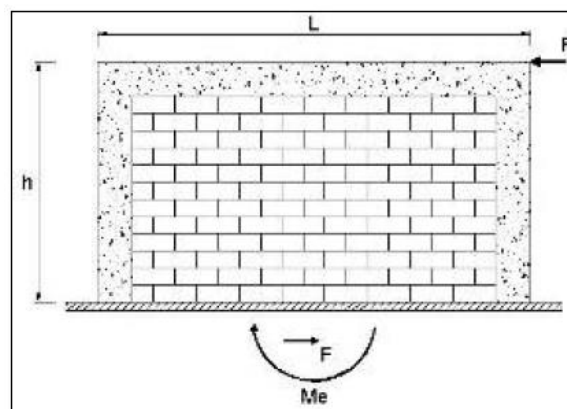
Fuerza cortante y momento en muro de vivienda de un piso (Fuente: Laucata, 2013)
